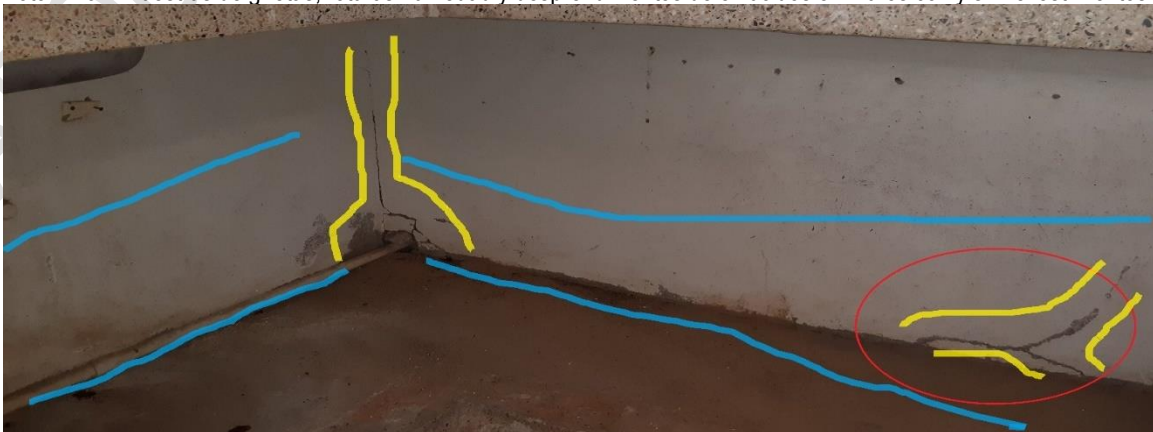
Evidencia de fisuras, grietas, fracturas y humedades en muros con y sin revestimientos.
